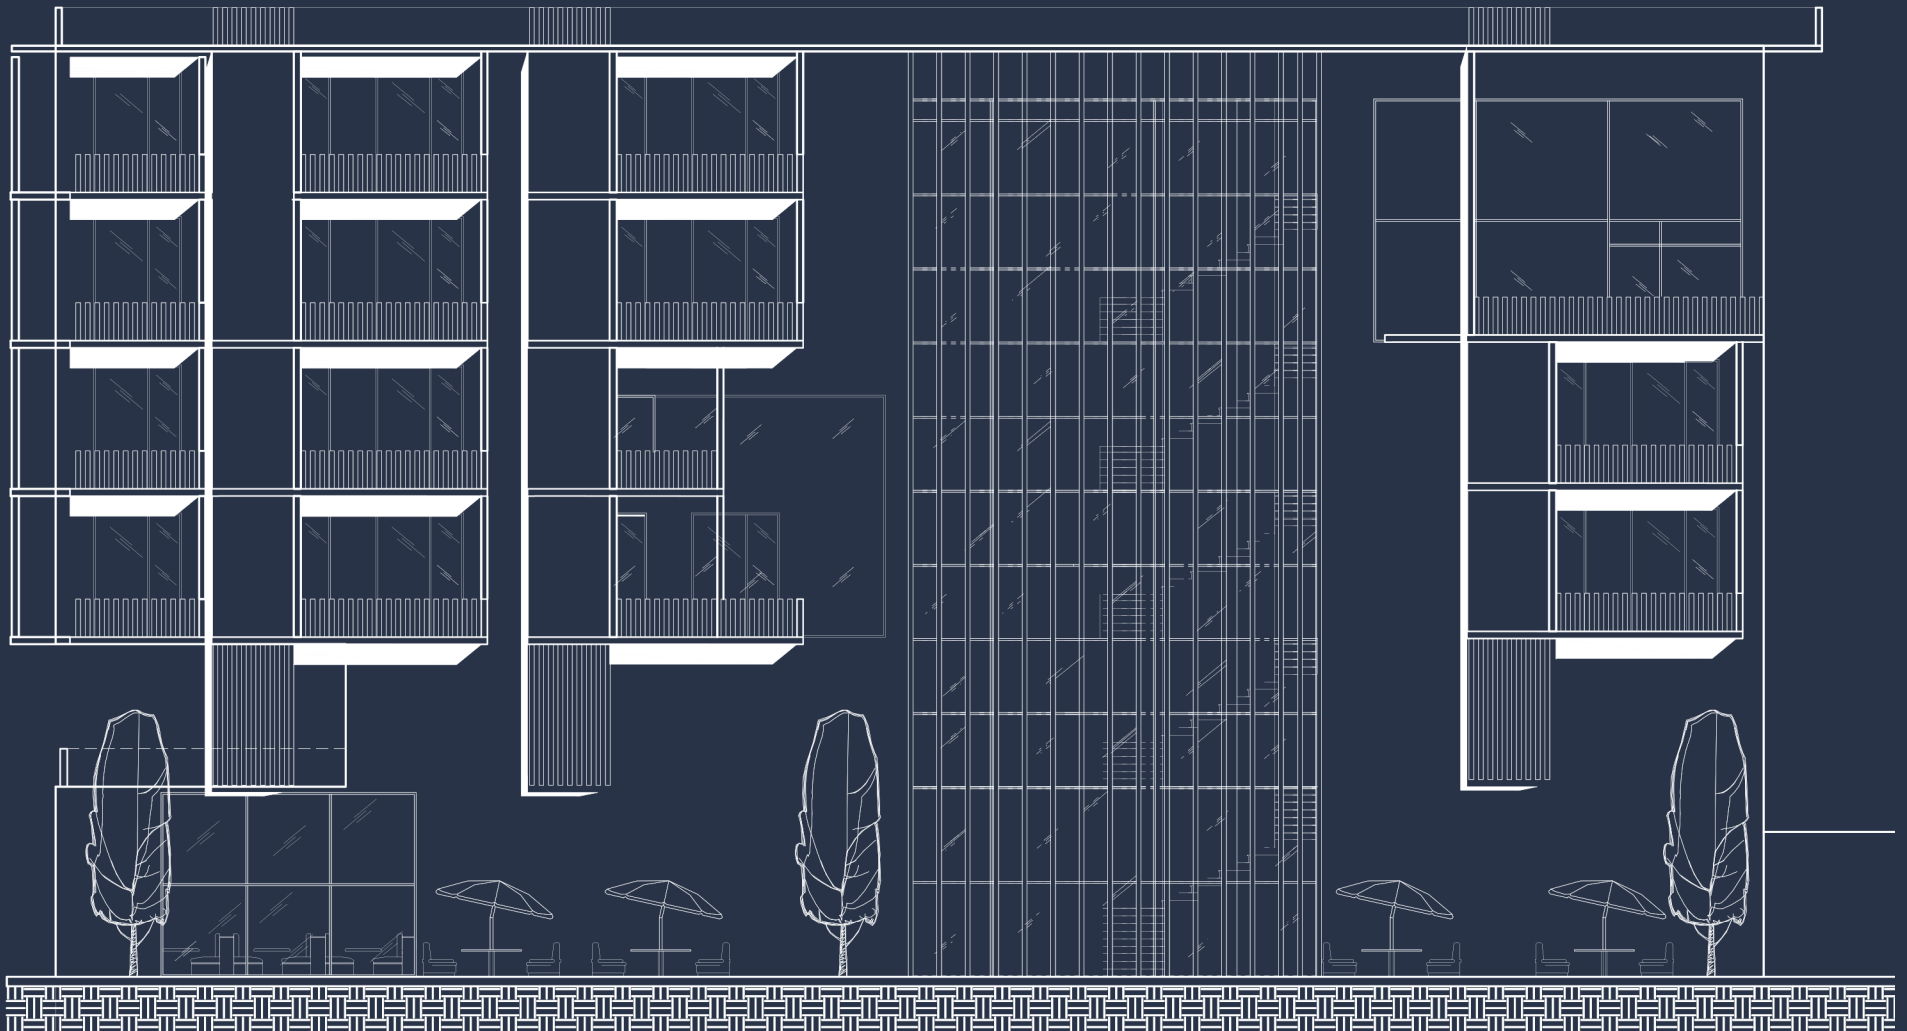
Facha de la residencia EMVIV. creación propia 2022
